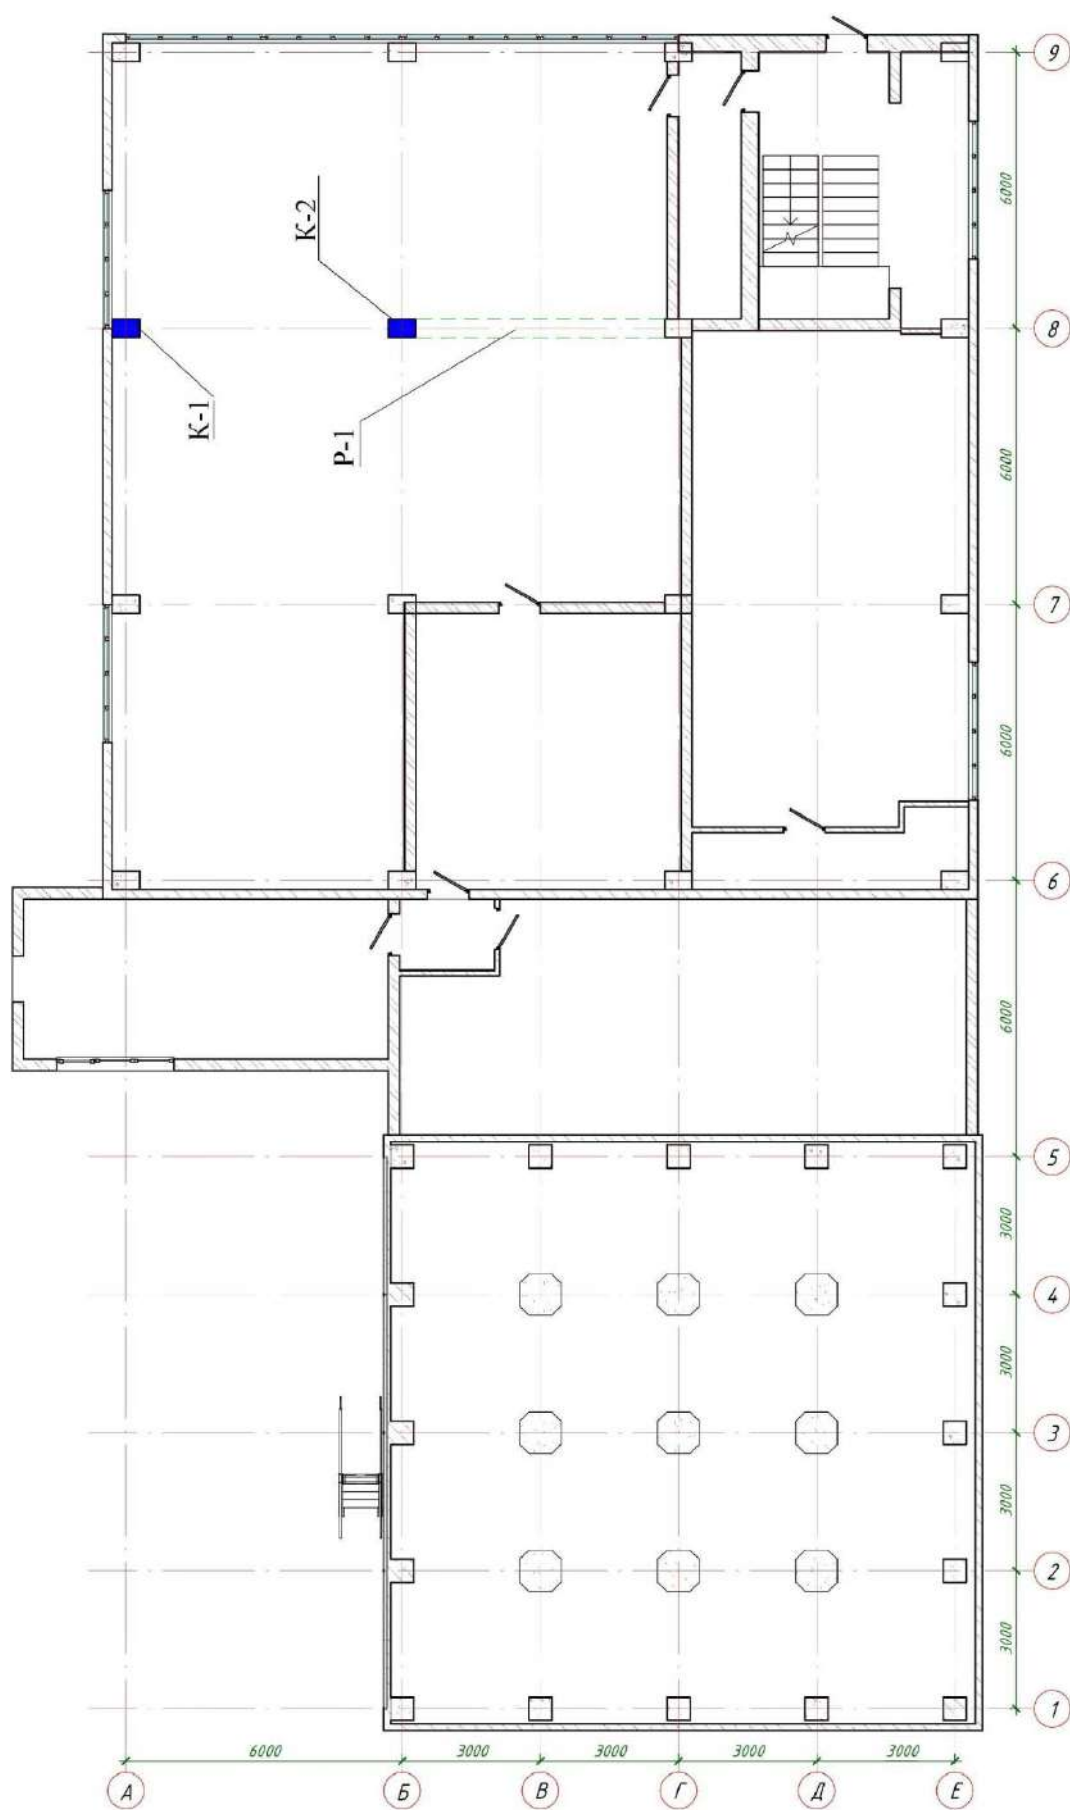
Схема розташування місць інструментальних досліджень залізобетонних конструкцій будівлі
